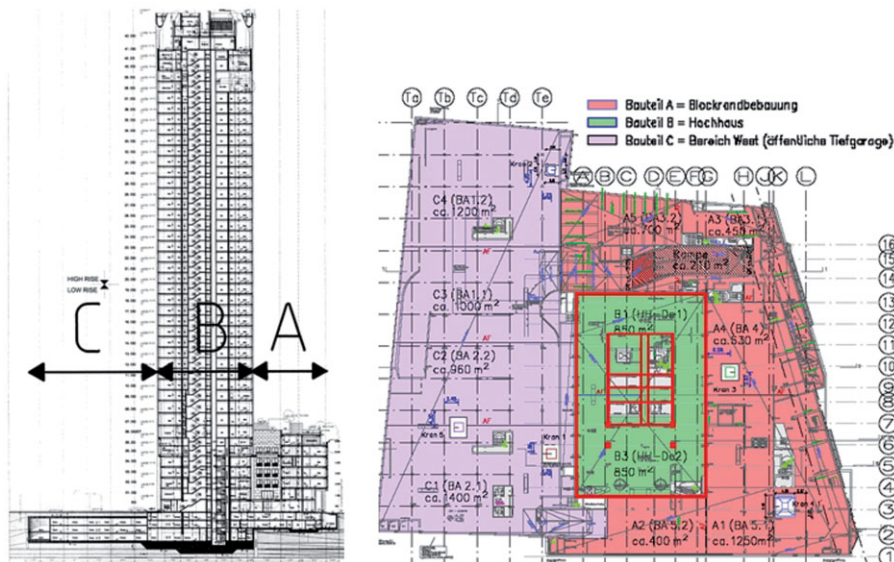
Vertikalschnitt durch das Gebäude und Gebäudegrundriss
